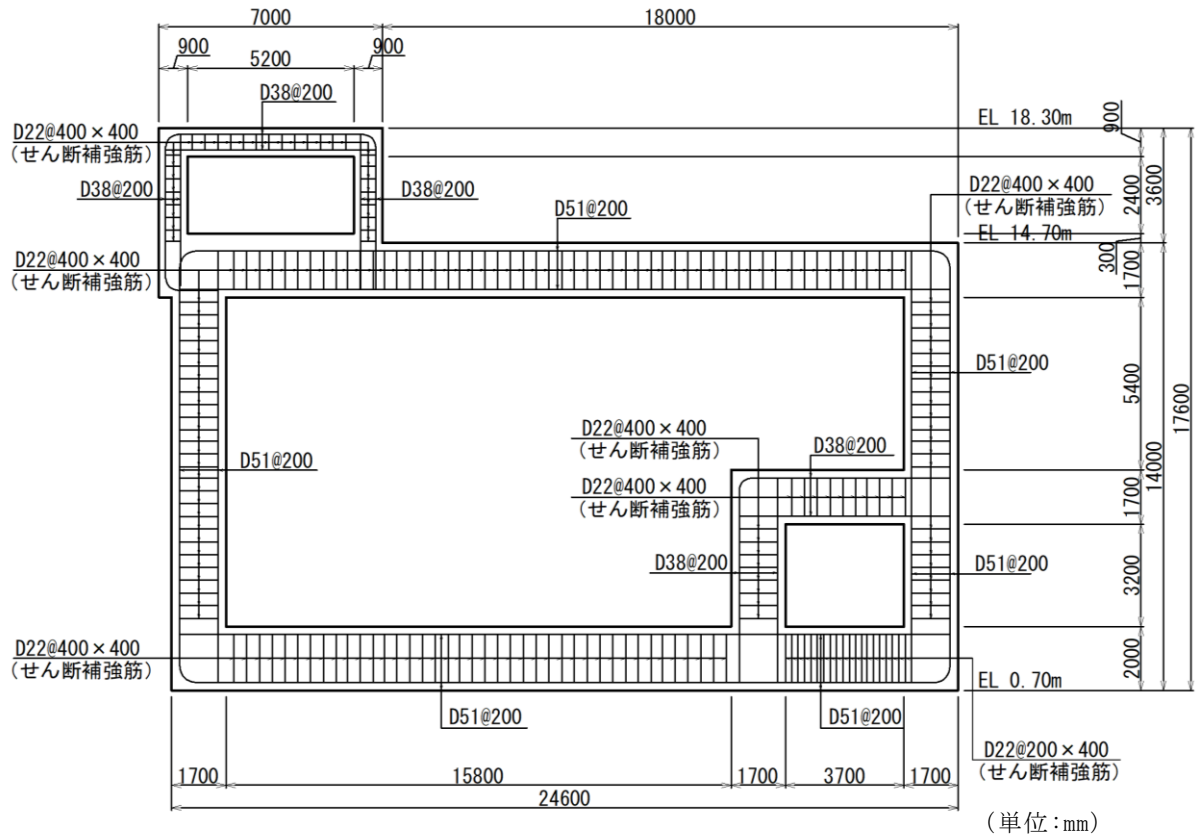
第 1 ベントフィルタ格納槽概略配筋図 (C-C 断面)
